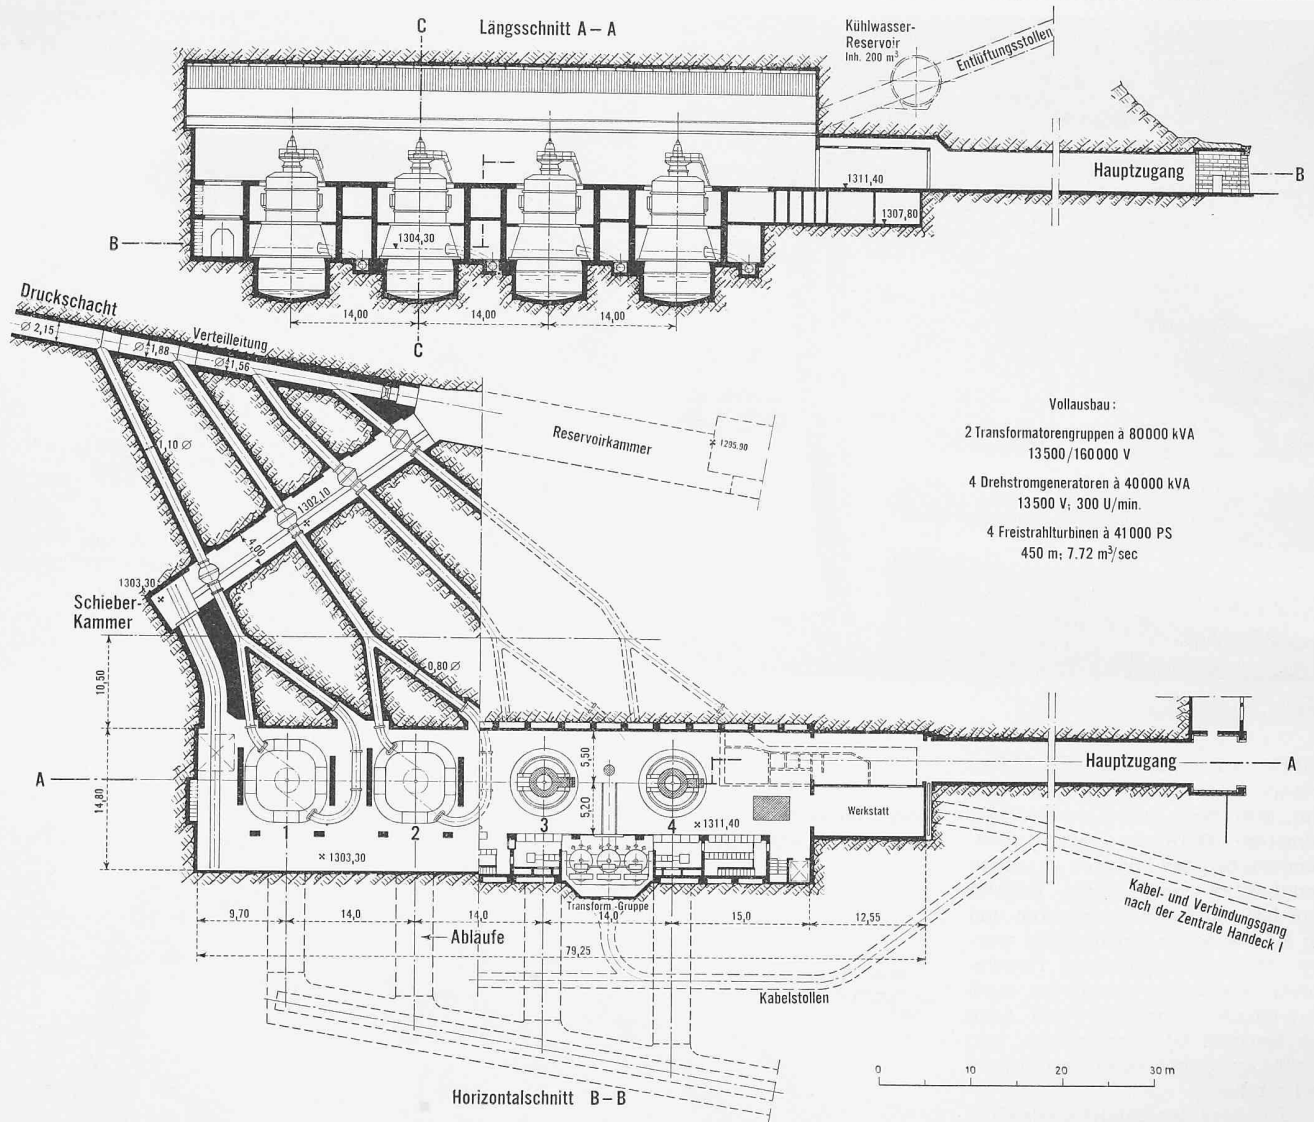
Zentrale Handeck II, Grundriss und Längsschnitt 1:800
